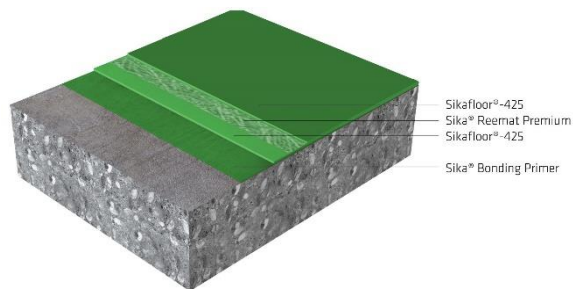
SIKAFLOOR®-425 Waterdichtingssysteem
